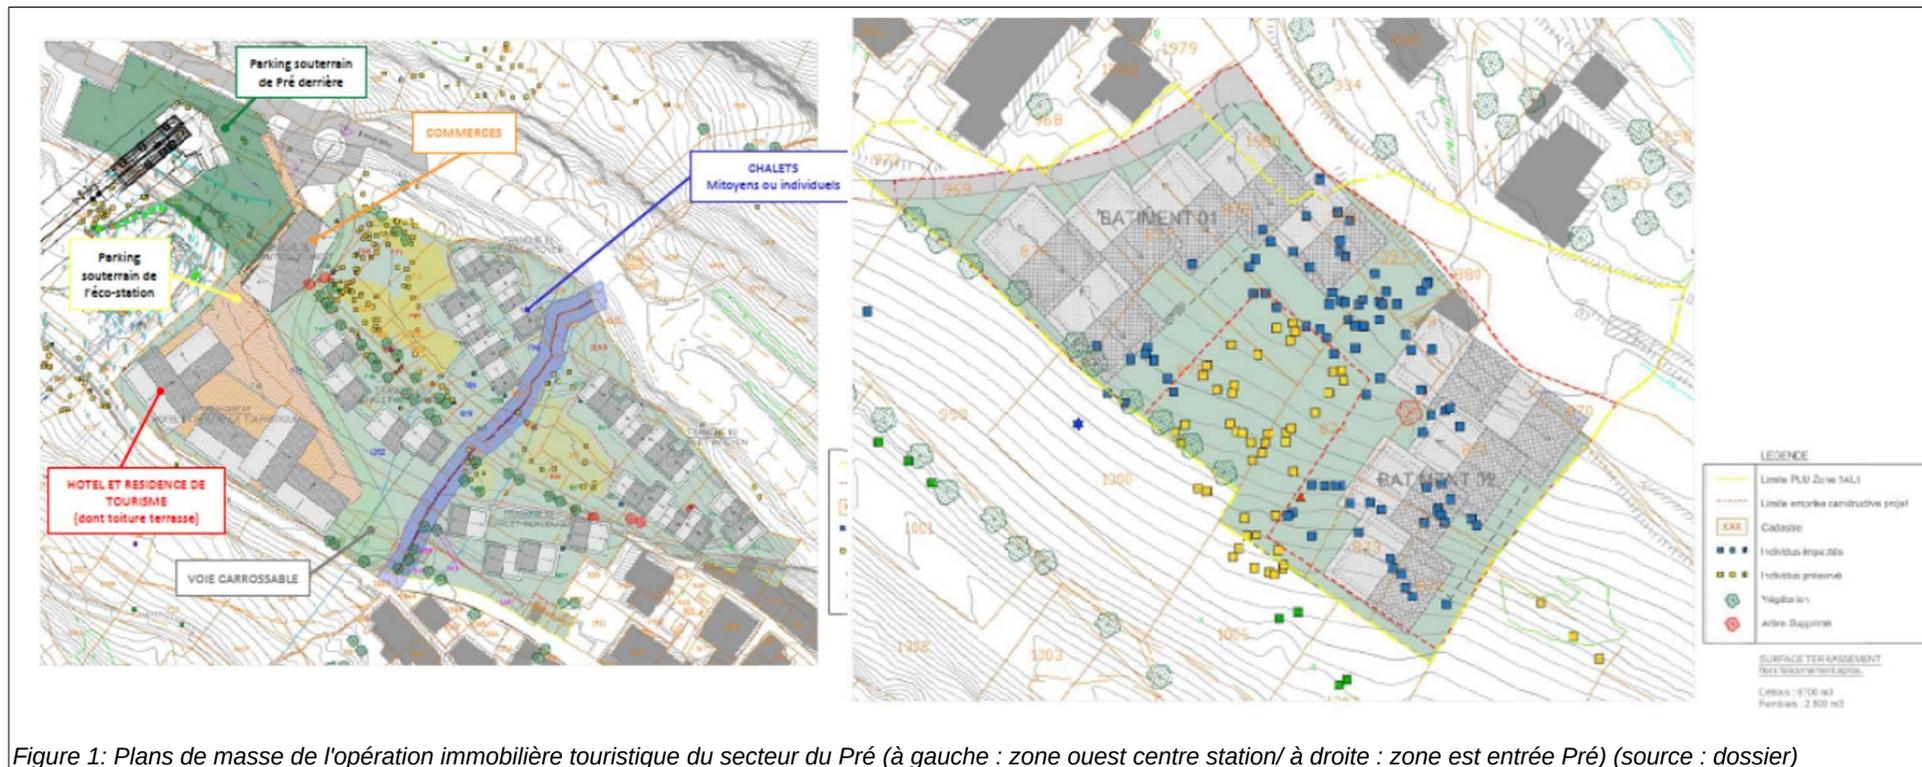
Plans de masse de l'opération immobilière touristique du secteur du Pré (à gauche : zone ouest centre station/ à droite : zone est entrée Pré) (source : dossier)
